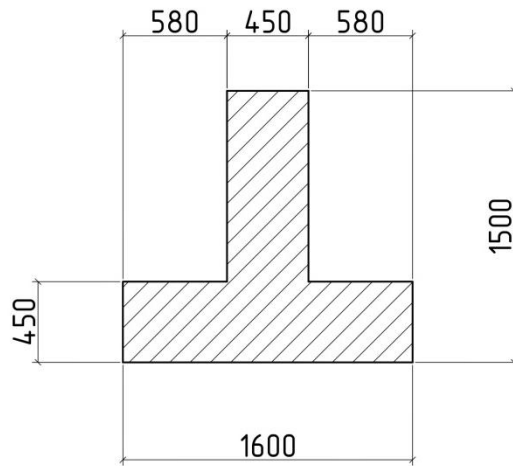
Поперечний переріз розрахованого фундаменту
